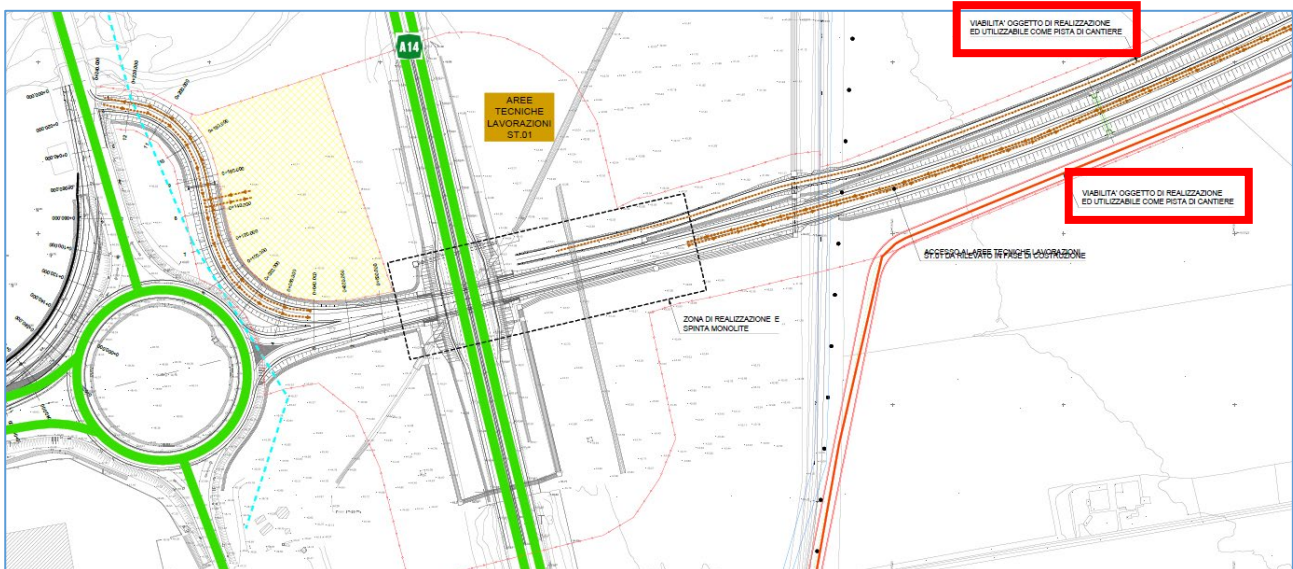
viabilità per accesso alle aree tecniche di lavorazione del ST.01
